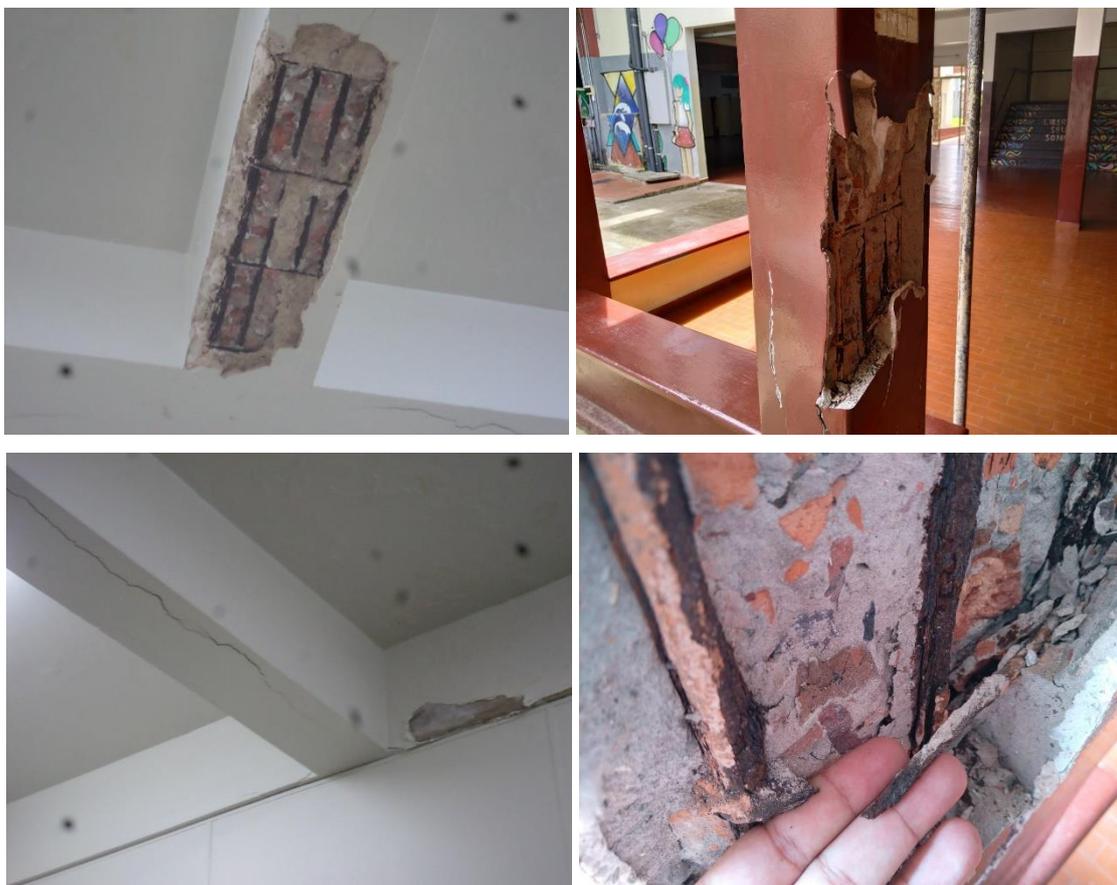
Concreto com cacos de tijolos e armaduras expostas em vigas e pilares (direita)
